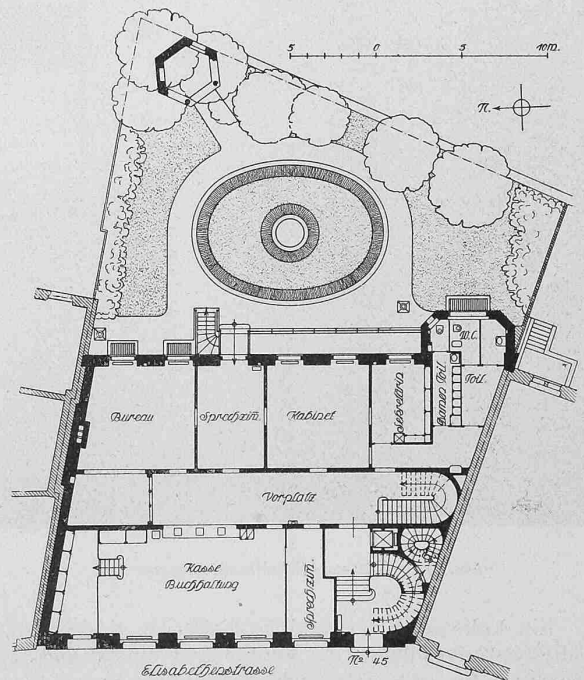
bis 3. Grundrisse vom Erdgeschoss, I. u. III. Stock. — 1:400.
